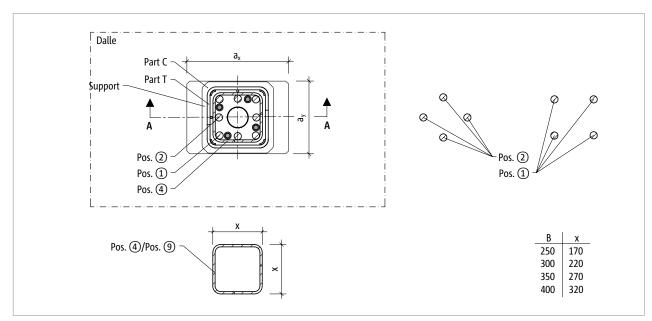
Schöck Sconnex® type P : renforcement sur site dans la section du poteau
